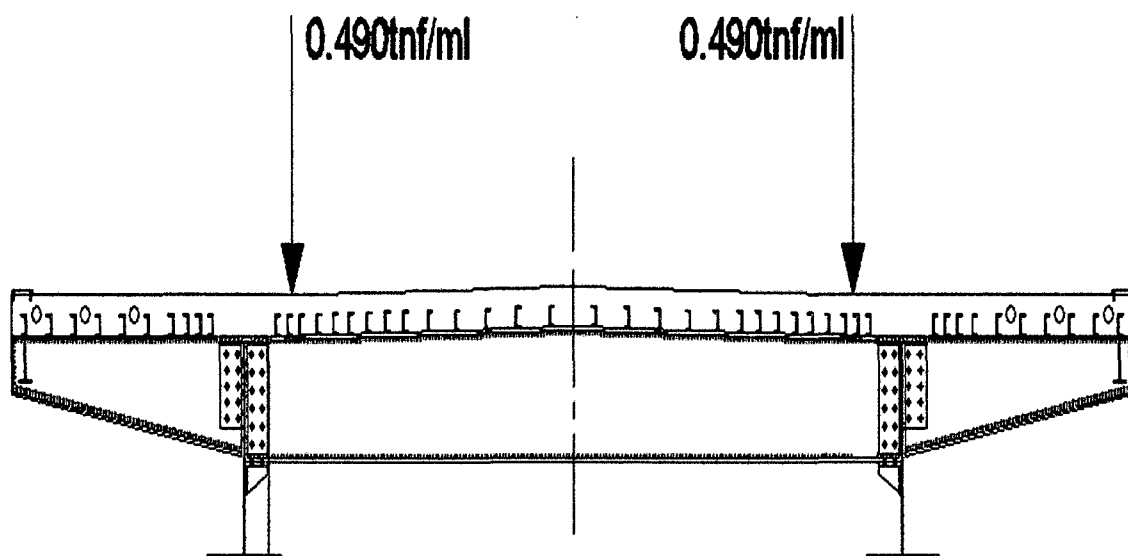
Sección Sometida a Carga de Parapeto.
